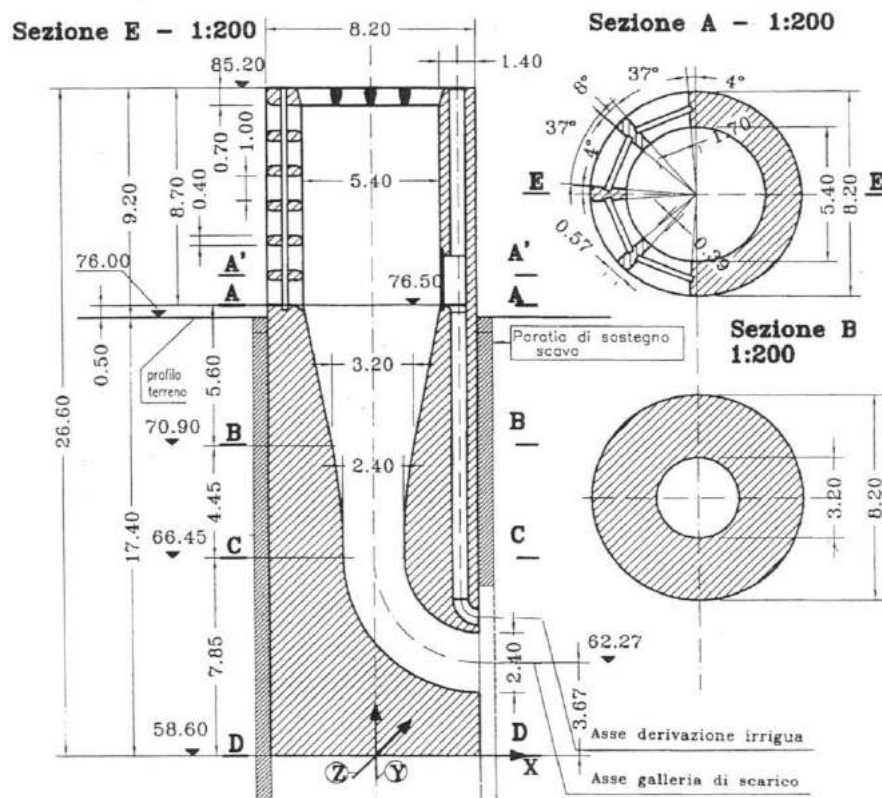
Sezione della nuova opera di imbocco scarico di fondo (alternativa progettuale)
